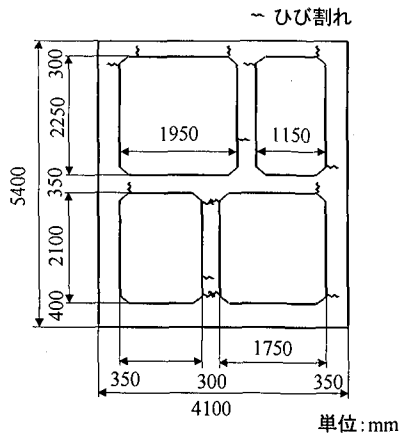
神戸共同溝の断面図とひび割れ状況
